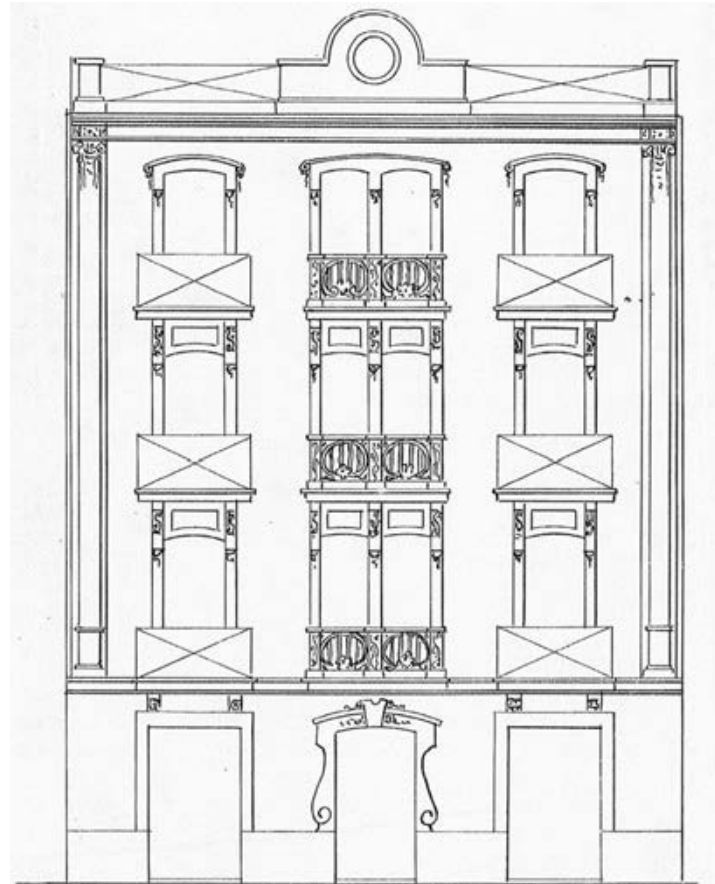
Edificio de 1912 en la calle Puerto Rico nº 26, compuesto de planta baja, tres plantas y buhardilla.
